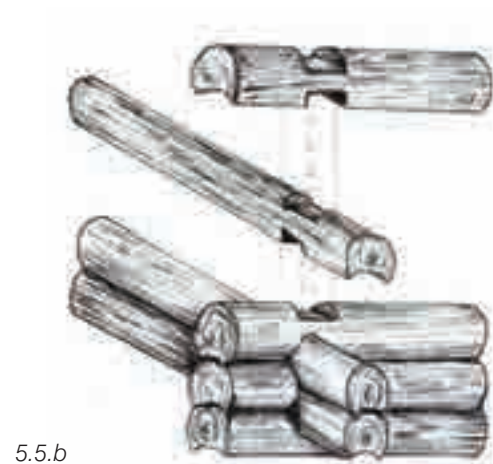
Sistema costruttivo con connessione ad anima o forcilla; vista dall'interno e dall'esterno.
